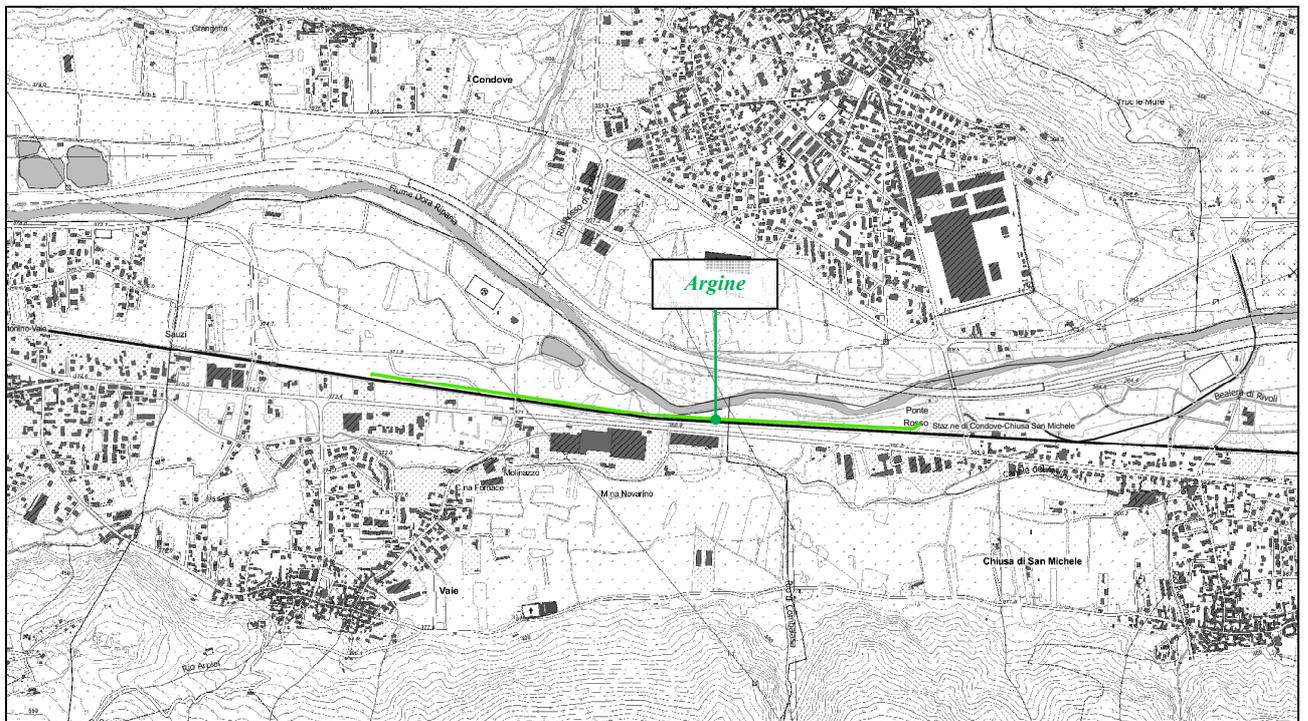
Stralcio planimetrico dell'argine in progetto.
